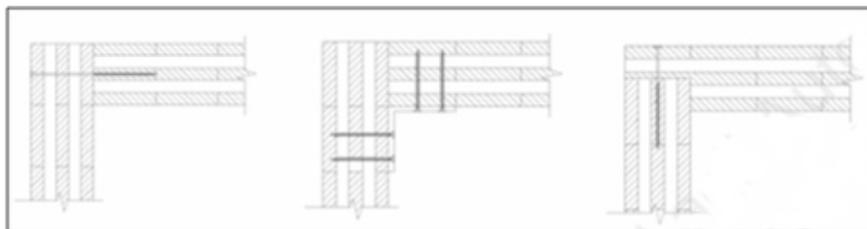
Alcuni particolari costruttivi dei collegamenti parete-parete d'angolo.
